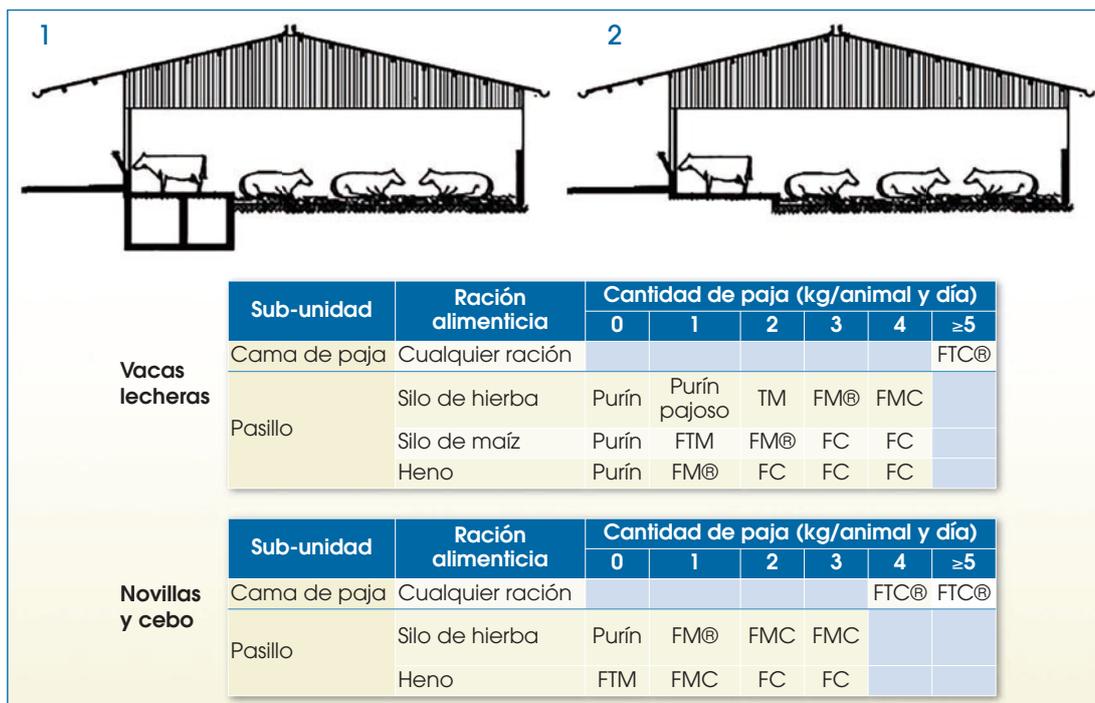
Tipo de alojamiento: 1) Área de reposo con paja y pasillo cubierto sobre enrejado; 2) Área de reposo con paja y murete o no de separación y pasillo cubierto sobre elevado y limpiado con arrobadera
